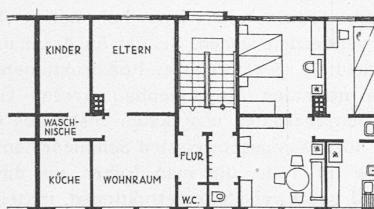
Grundriss des Holzskelett-Baublocks.
